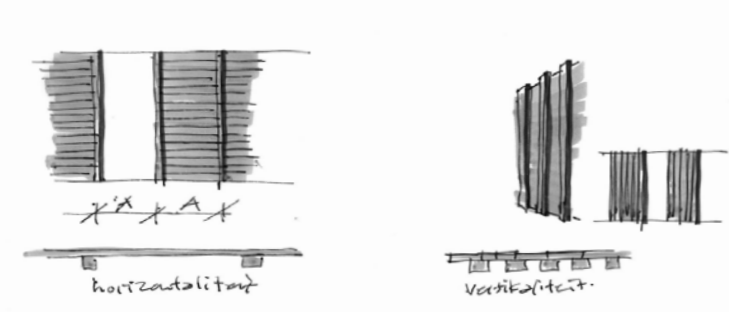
Schetsverkenning mogelijke uitwerking hoofdgebouw erf, woongebouwen en verbindingen
